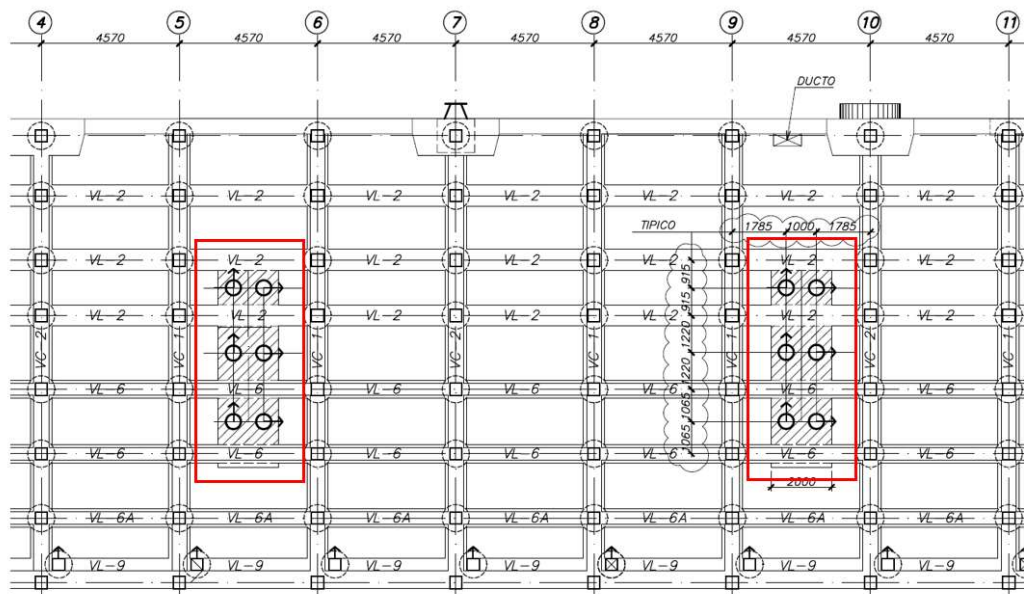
Grupo de pilotes tubulares e inclinados de acero
